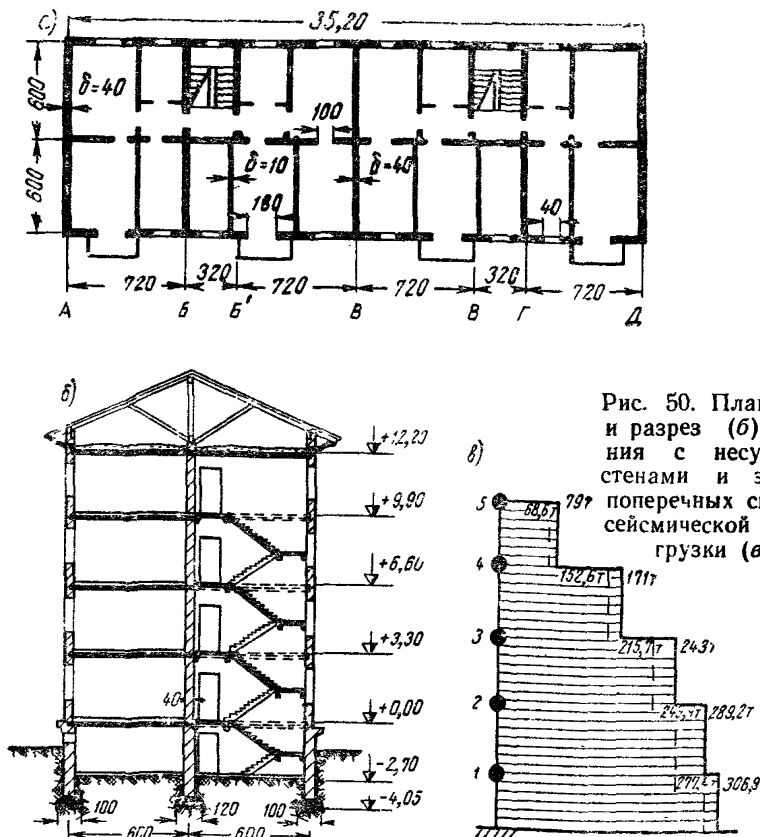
План (а) и разрез (б) здания с несущими стенами и эпюра поперечных сил от сейсмической нагрузки (в)
